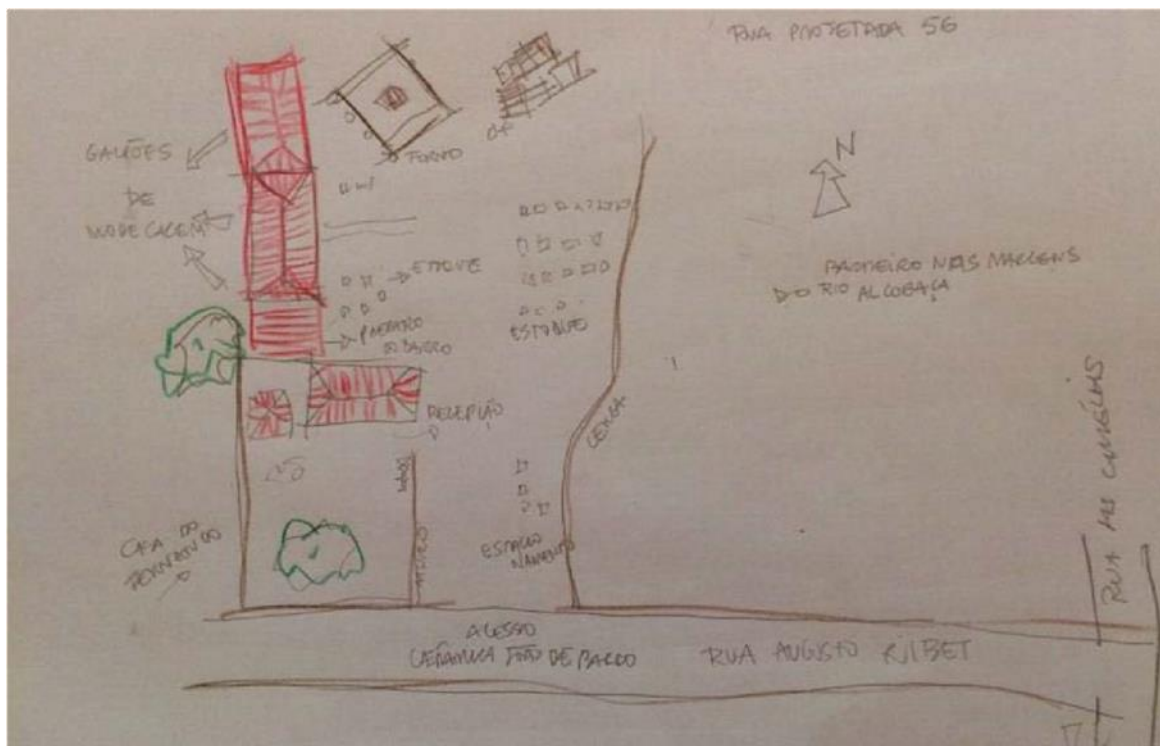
Planta Baixa da Olaria João de Barro¹¹
